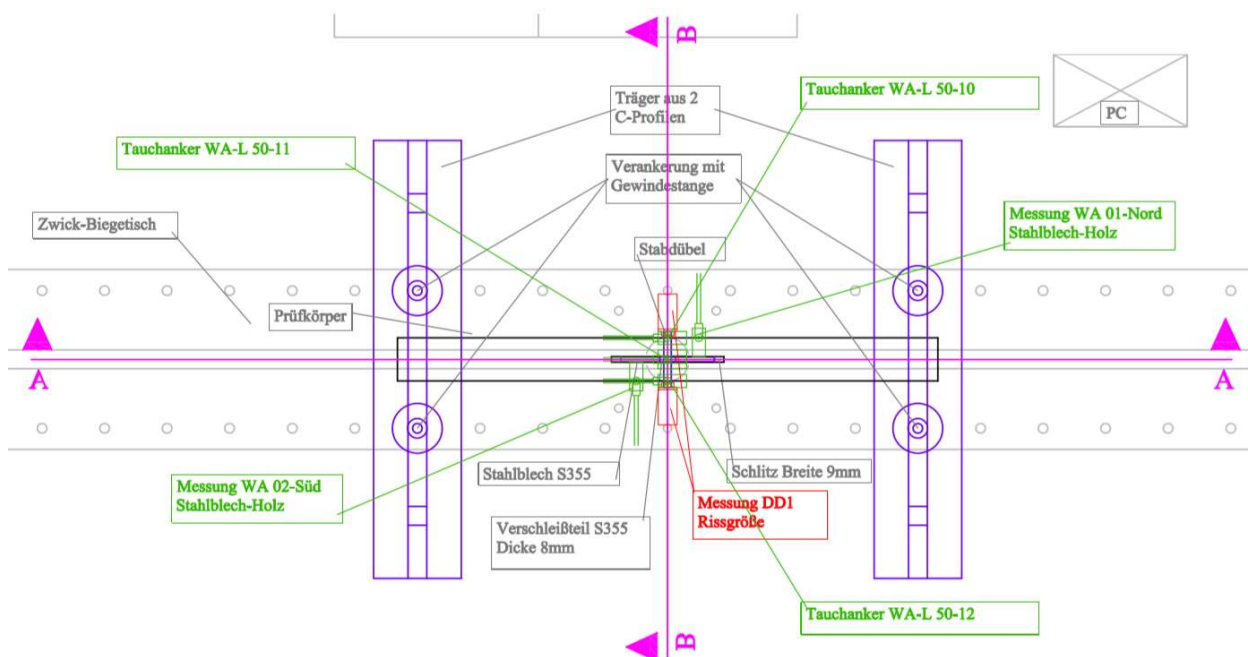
Grundriss der Prüfkongfiguration der Hauptversuche
